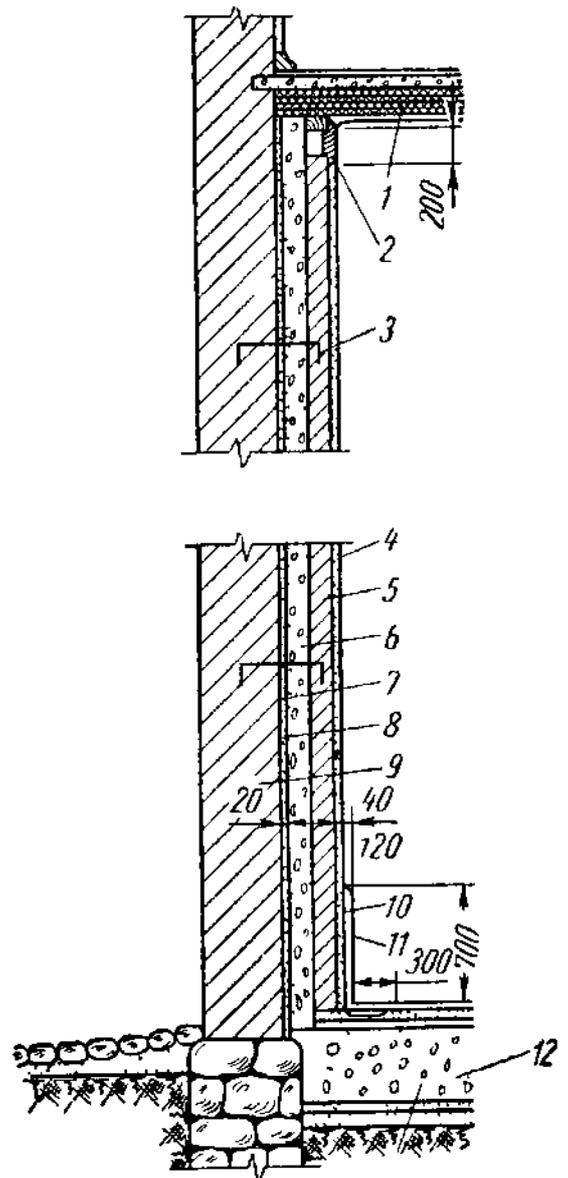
Изоляция кирпичной стены засыпным материалом:
